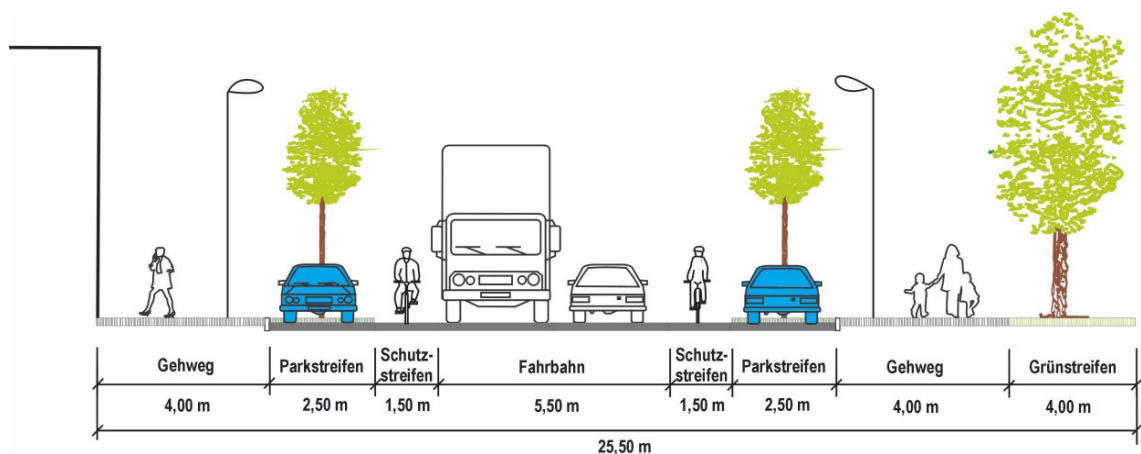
Querschnitt Rosa-Luxemburg-Straße, Umgestaltungsvariante 1 (Vorzugsvariante)
